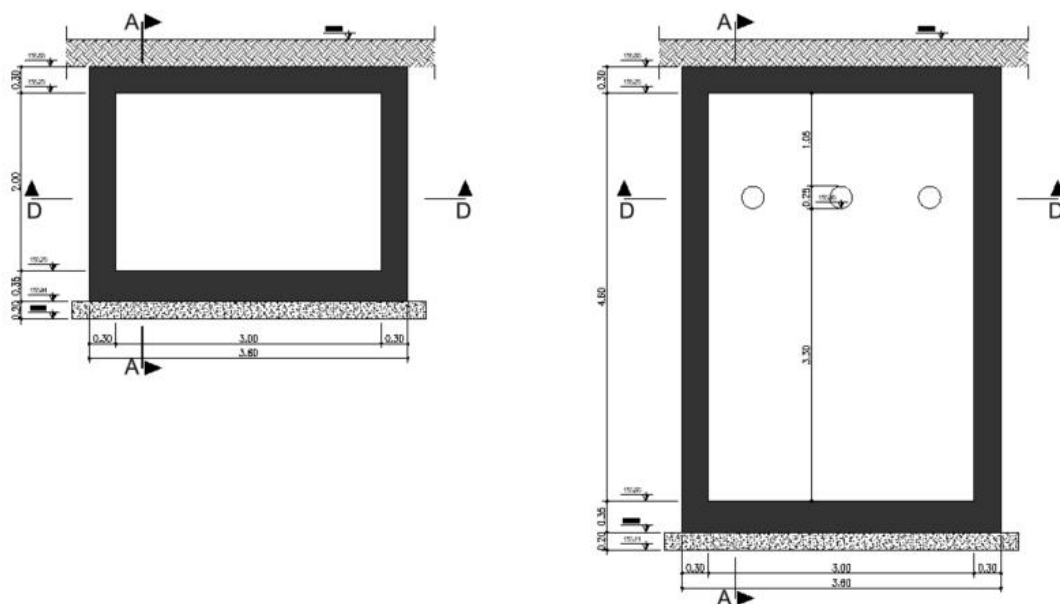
Sezione B-B (sx) e sezione C-C (dx), manufatto di sollevamento.
